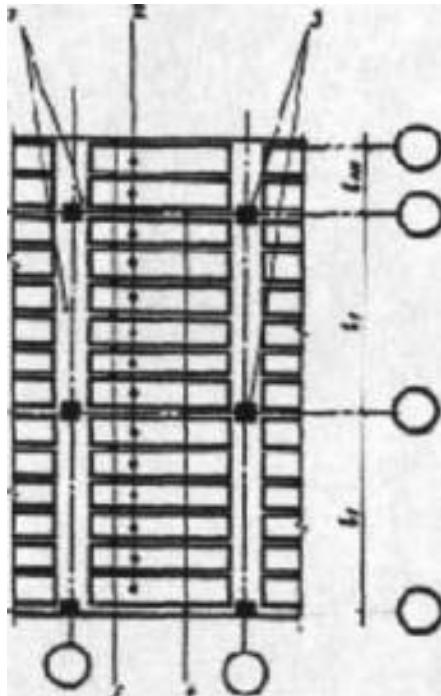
Фрагмент сборно-монолитного плоского перекрытия «Сочи»
